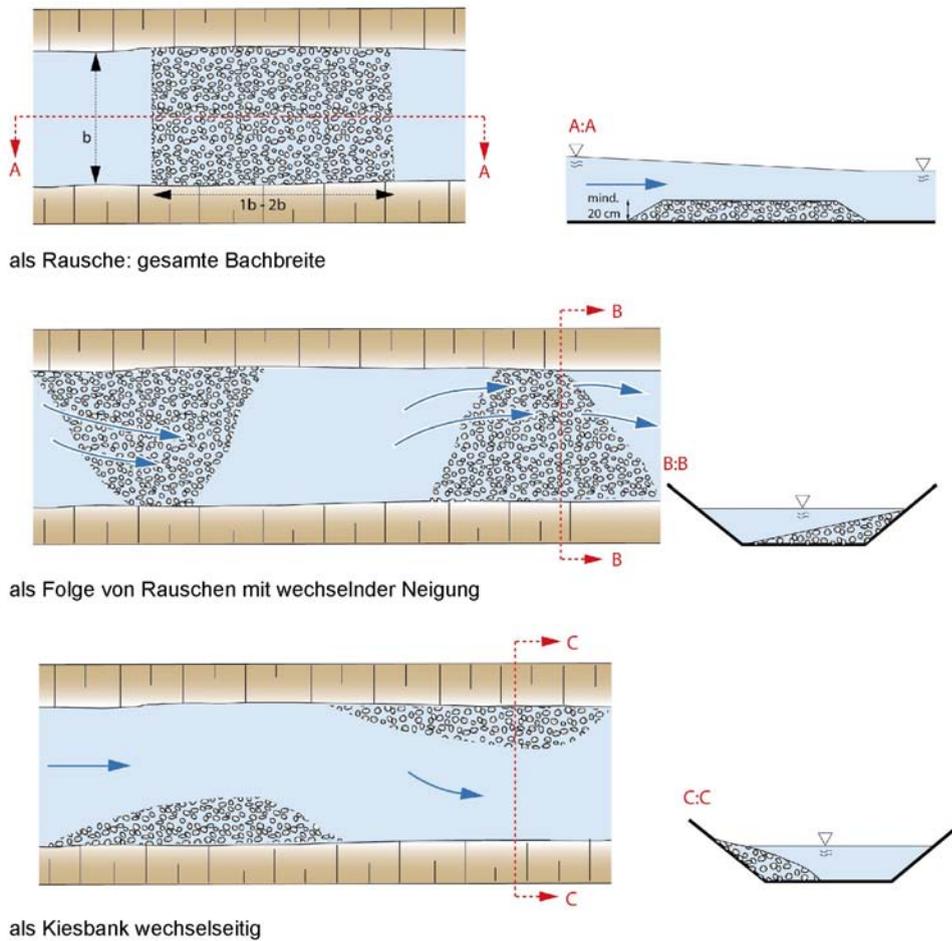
Drei Beispiele für das Einbringen von Kies, jeweils in der Draufsicht und im Querschnitt
